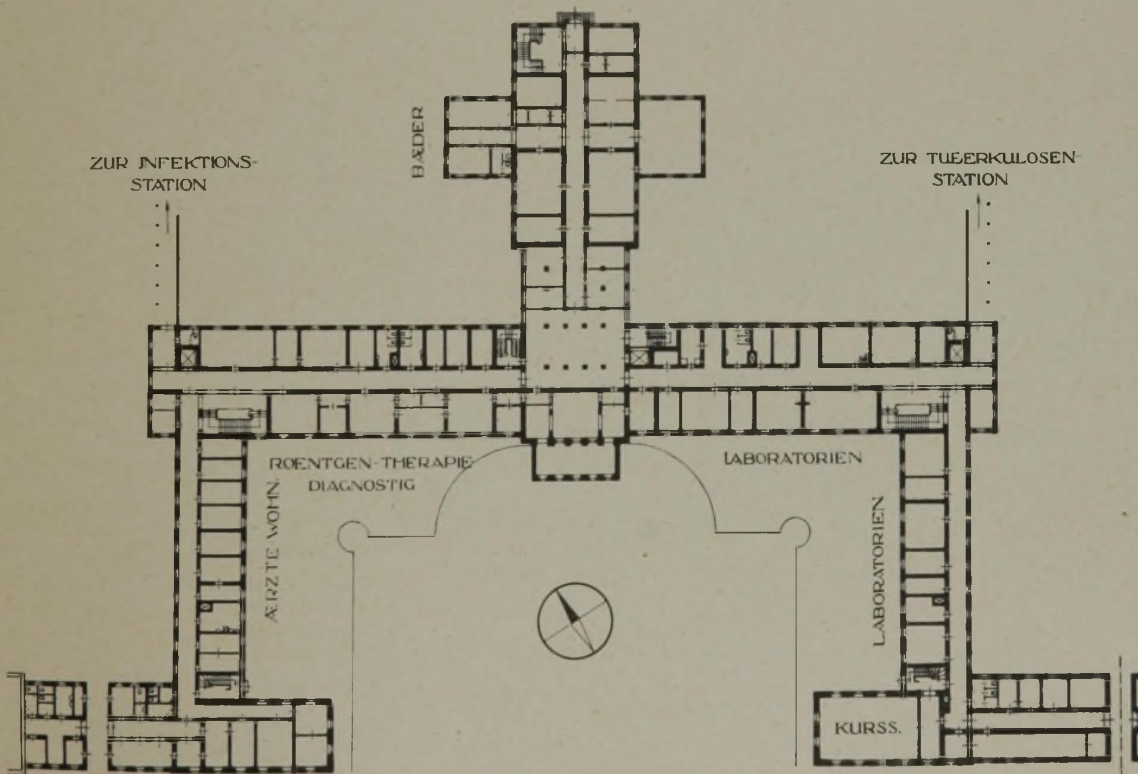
Grundriß des Erdgeschosses. (1 : 1000.)
